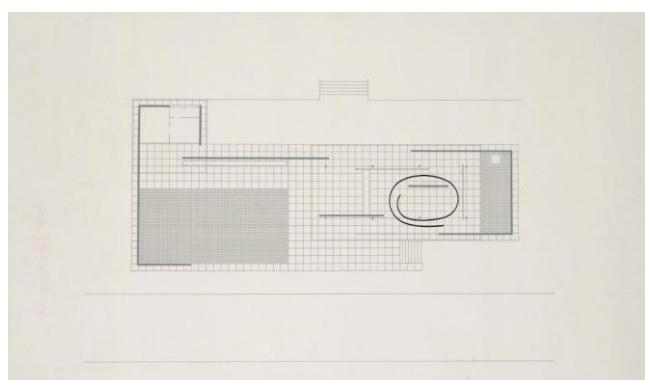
Collage esquema en planta de la obra de SANAA sobre planta del pabellón.
